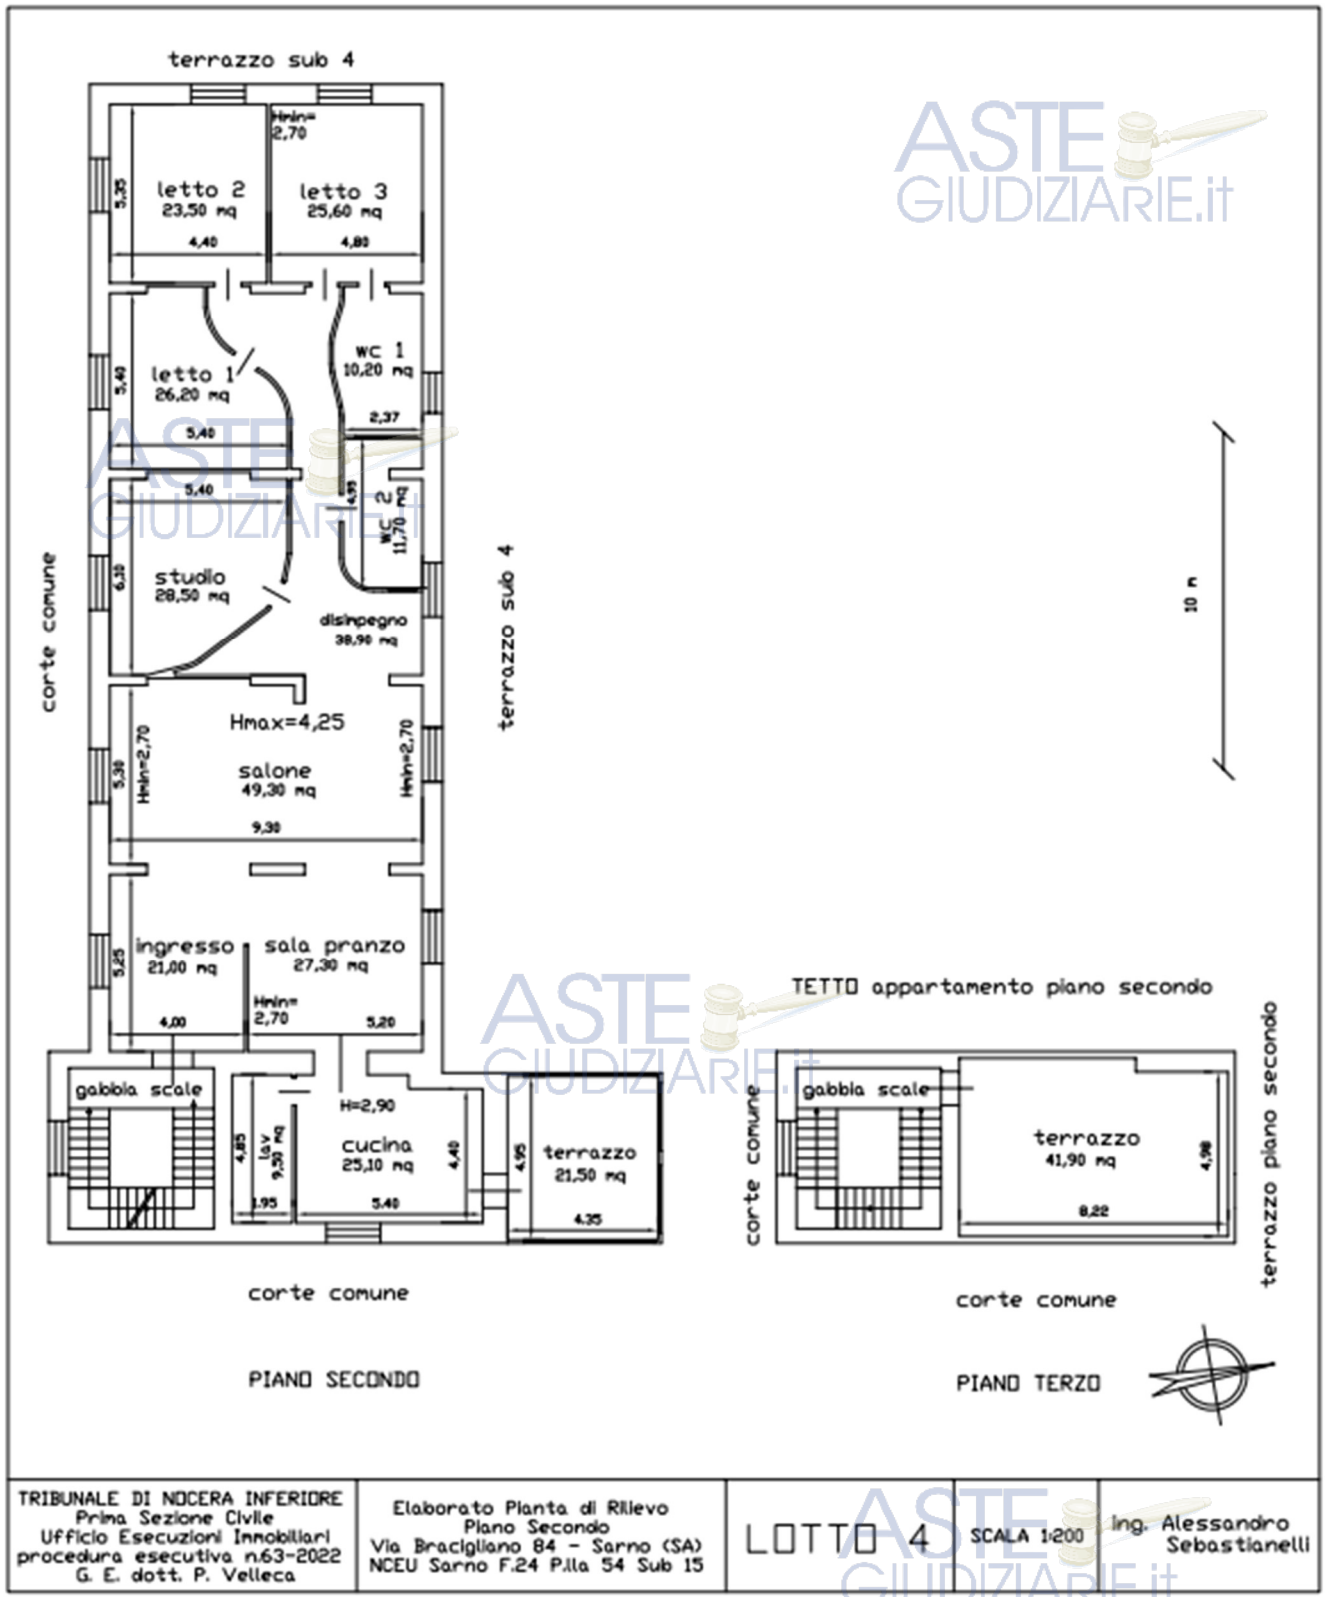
Planimetria stato di rilievo appartamento pignorato lotto 4 (F.24 p.Ila 54 sub 15)
